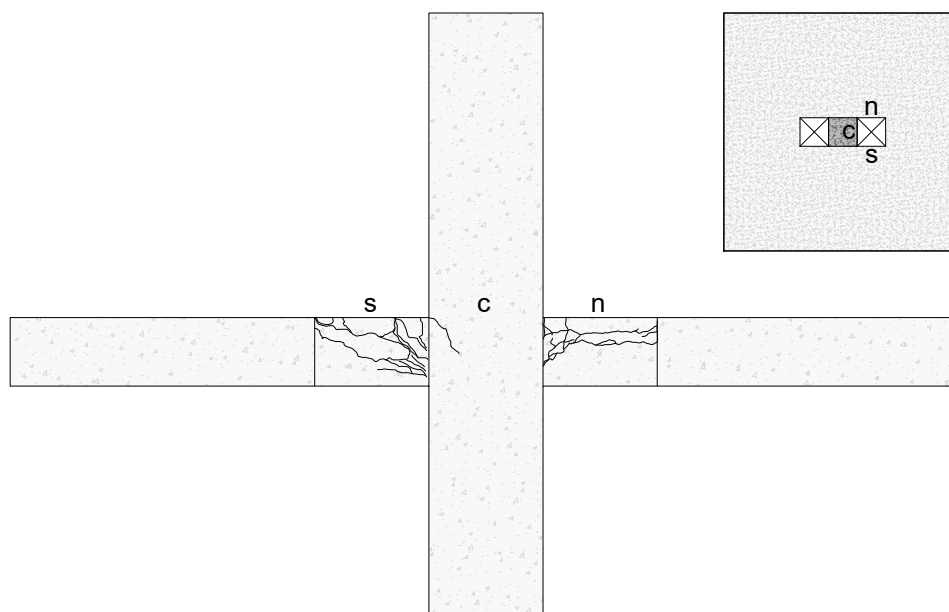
Padrão de fissuração da laje LRFS - vistas abertura
